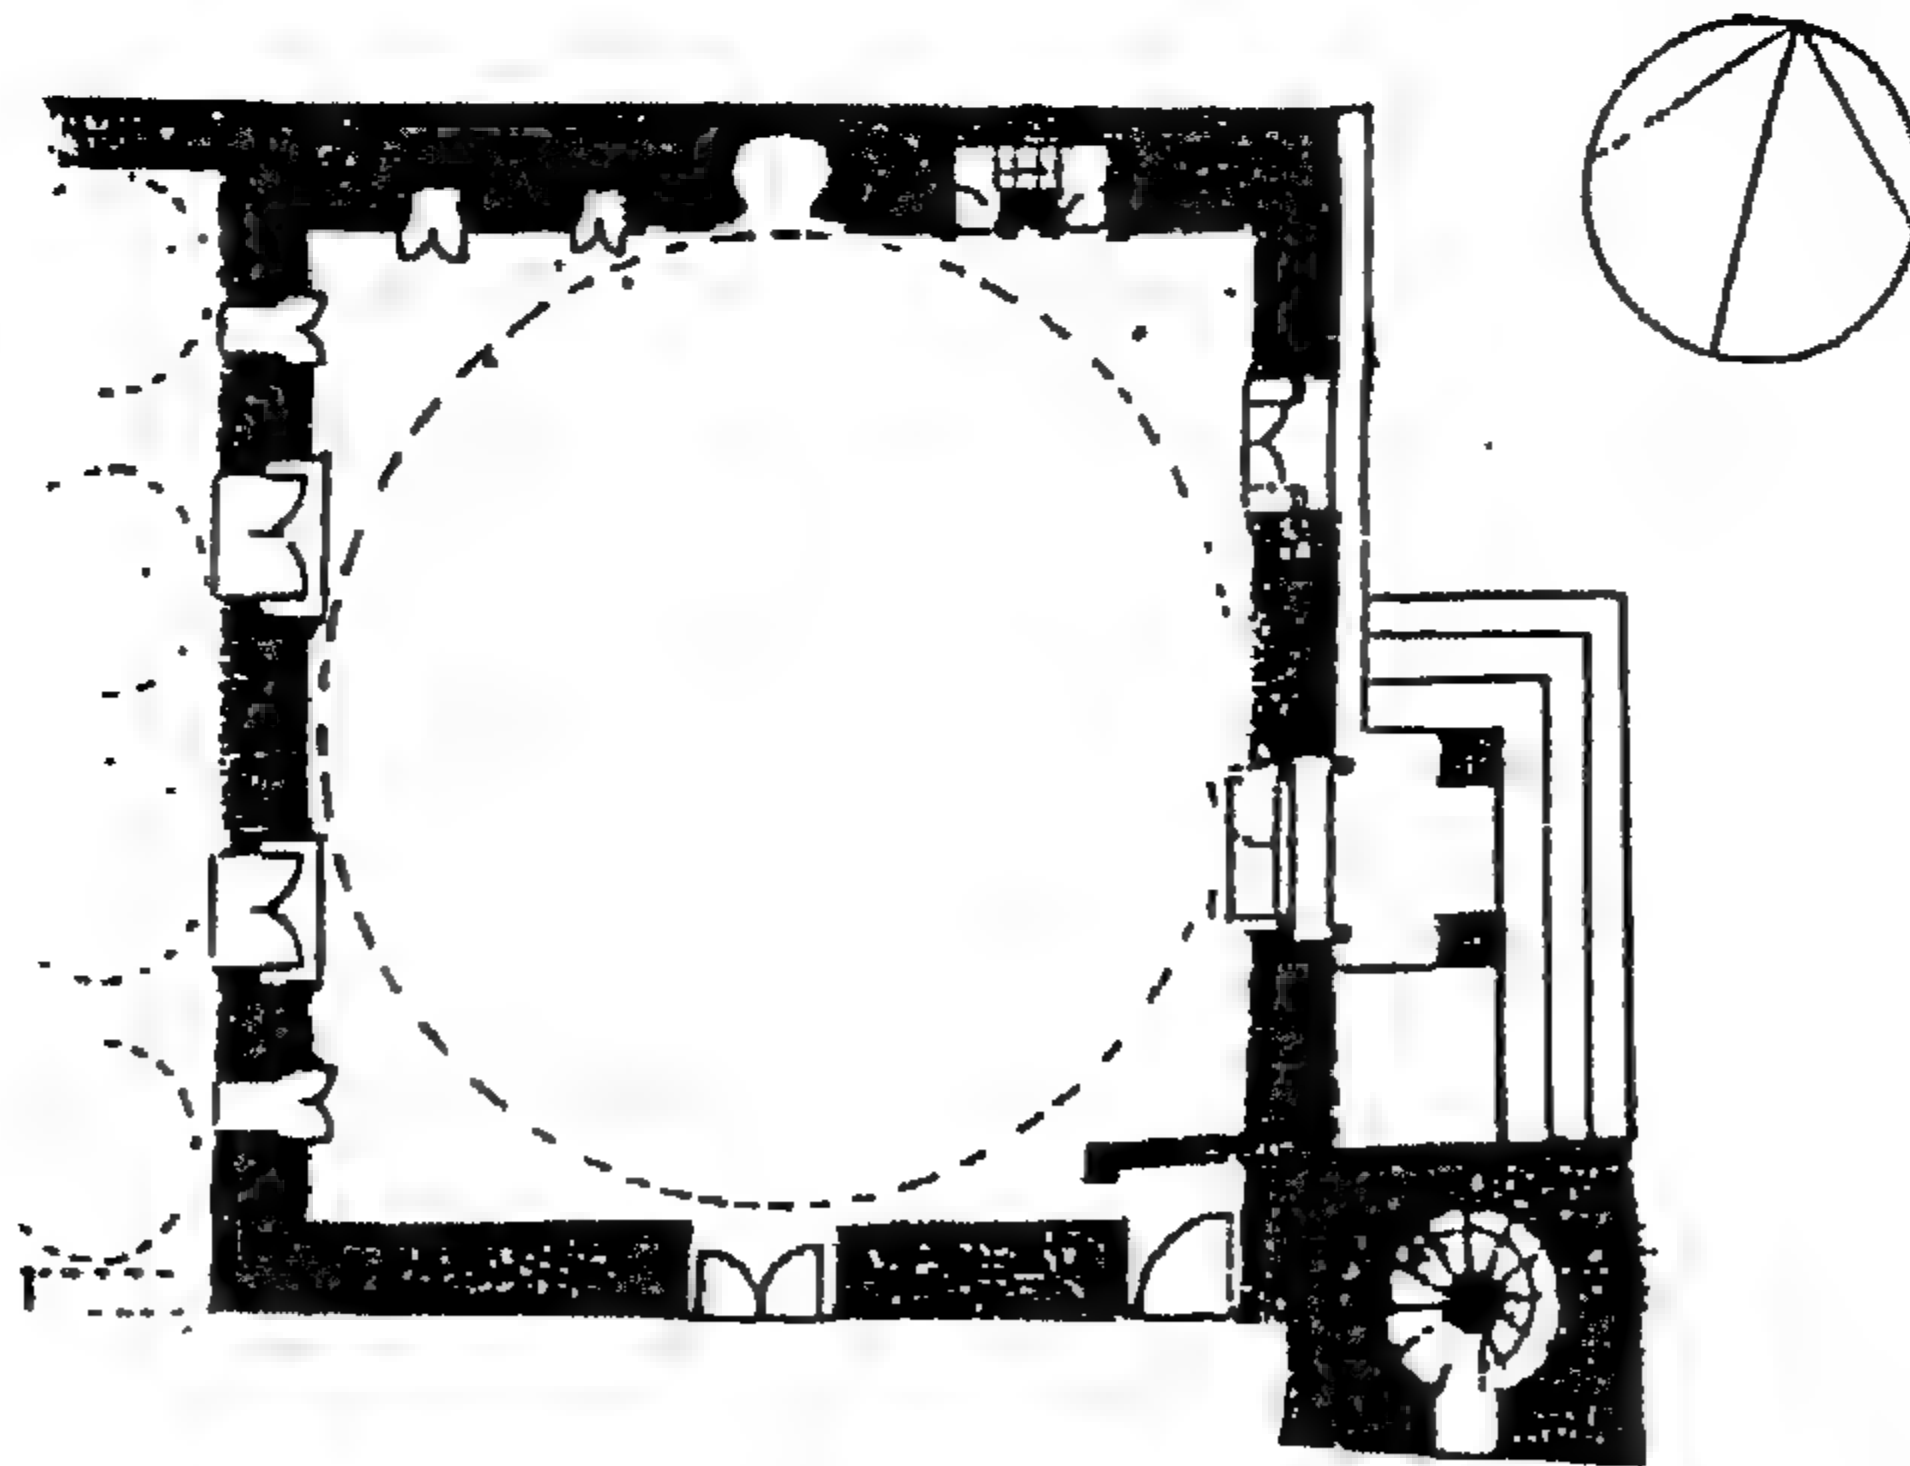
مسقط أفقي لمسجد تميم باليمن - (عن : فتستر) .
